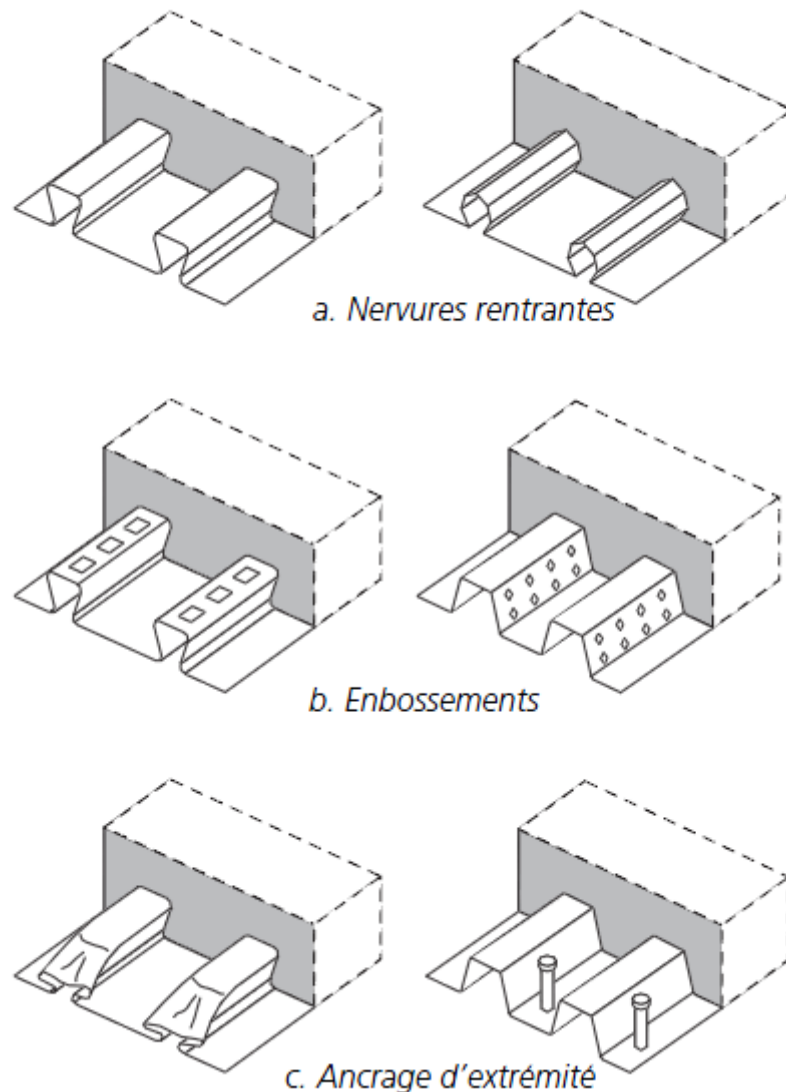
dalles mixtes coulées sur tôles nervurée avec connecteurs. [5]
